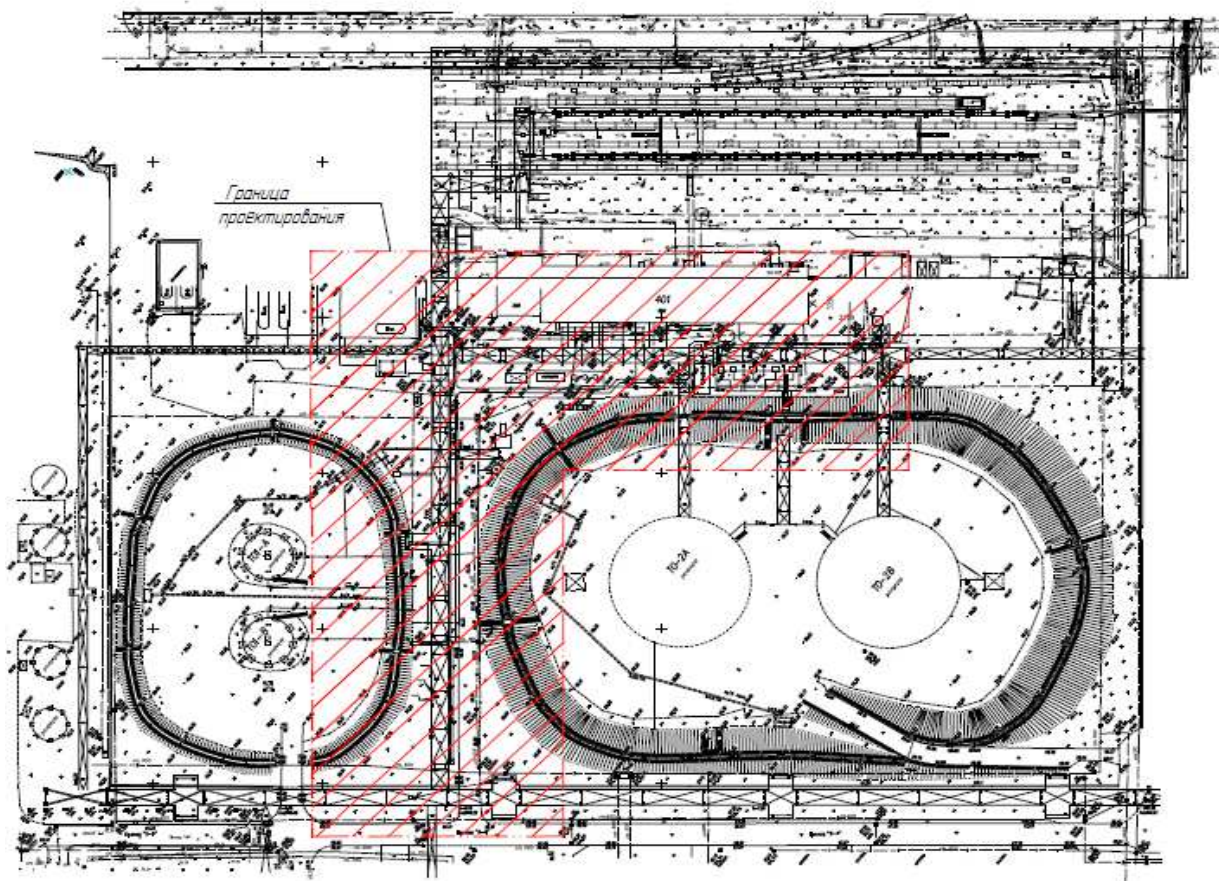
Генеральный план и границы проектирования узла выдачи и перекачки жидкого аммиака цеха №13
